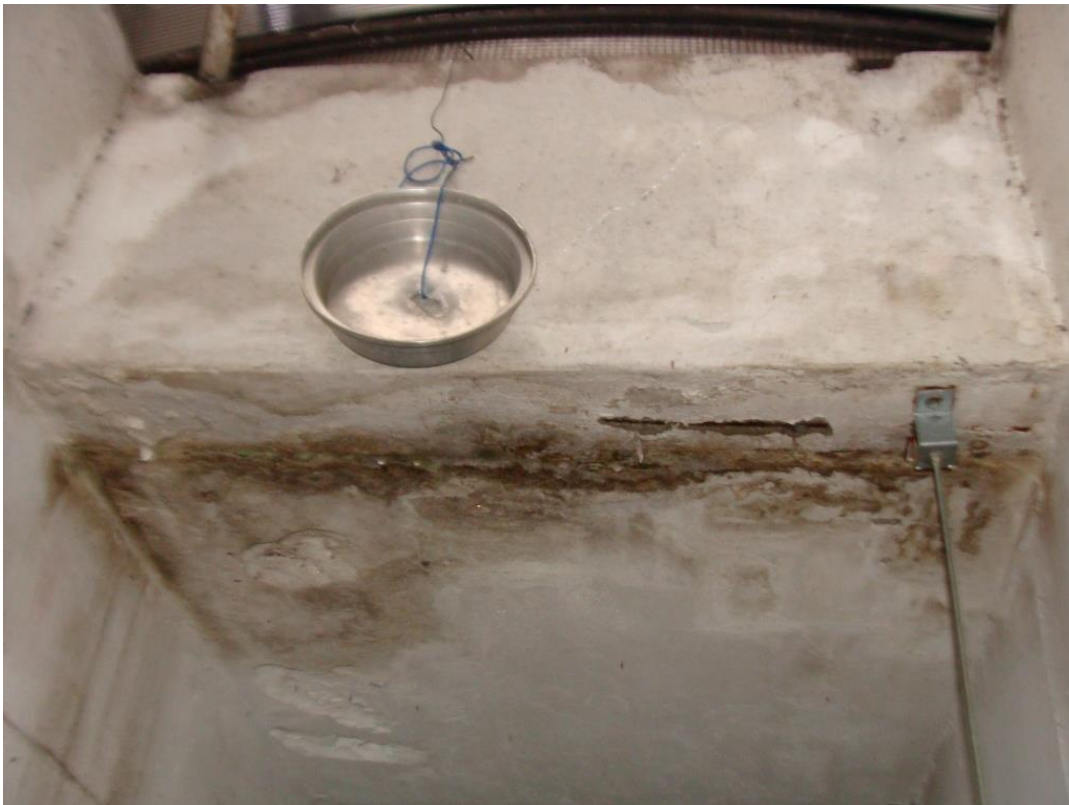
Sinais de infiltração com carreamento de corrosão na laje L7 (01/03/2013)
